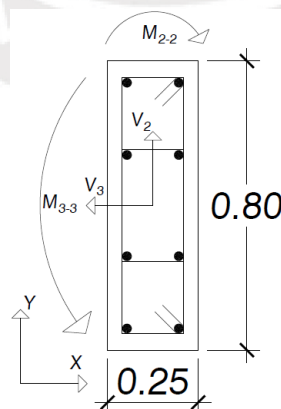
Sección y refuerzo ( $8 \phi 3/4''$ ) de la columna C-1
